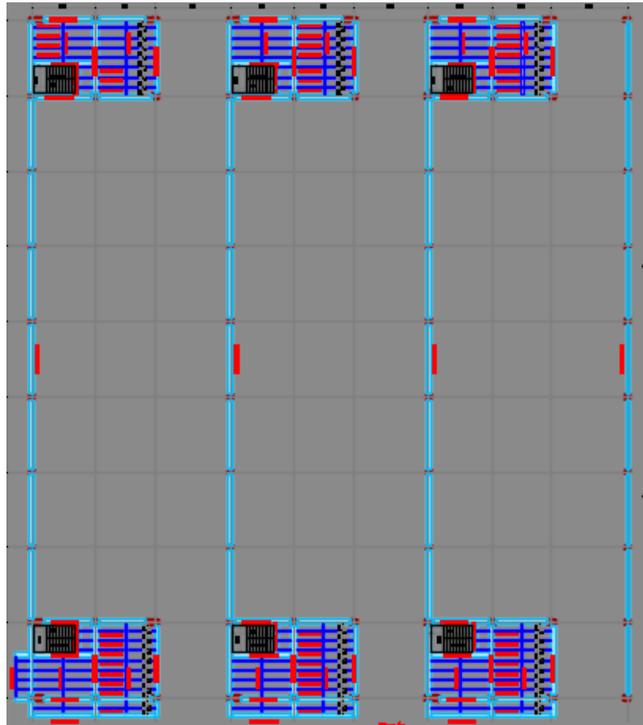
Localización de Vigas, Viguetas y Placas de Entrepiso Segundo Nivel.
